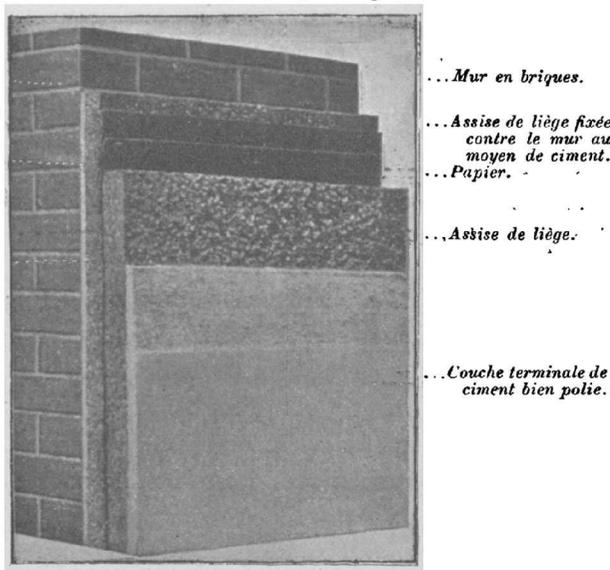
Isolement fait contre un mur en briques avec assises de liège, couches de papier imperméable alternées et couches de ciment.
